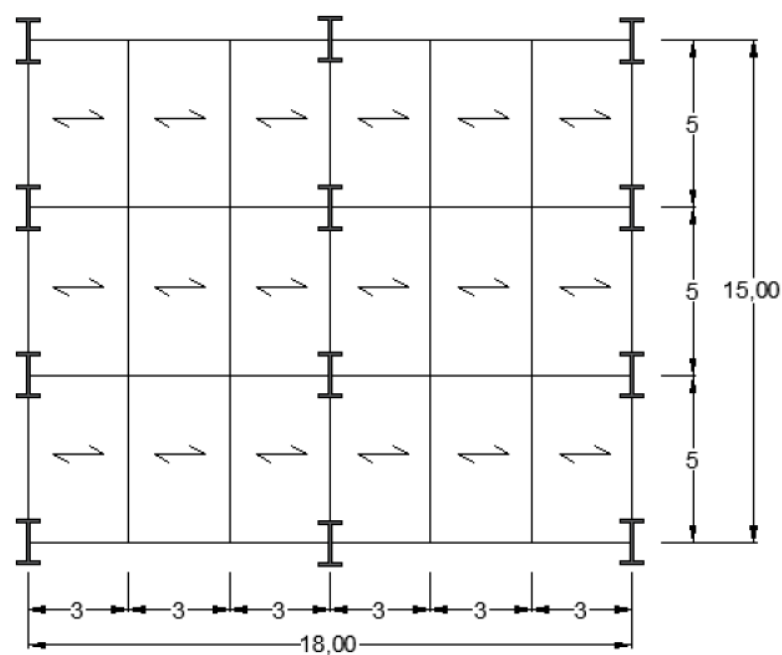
Esquema estrutural do caso 1 para a estrutura C (Fonte: Sandes, 2019)
